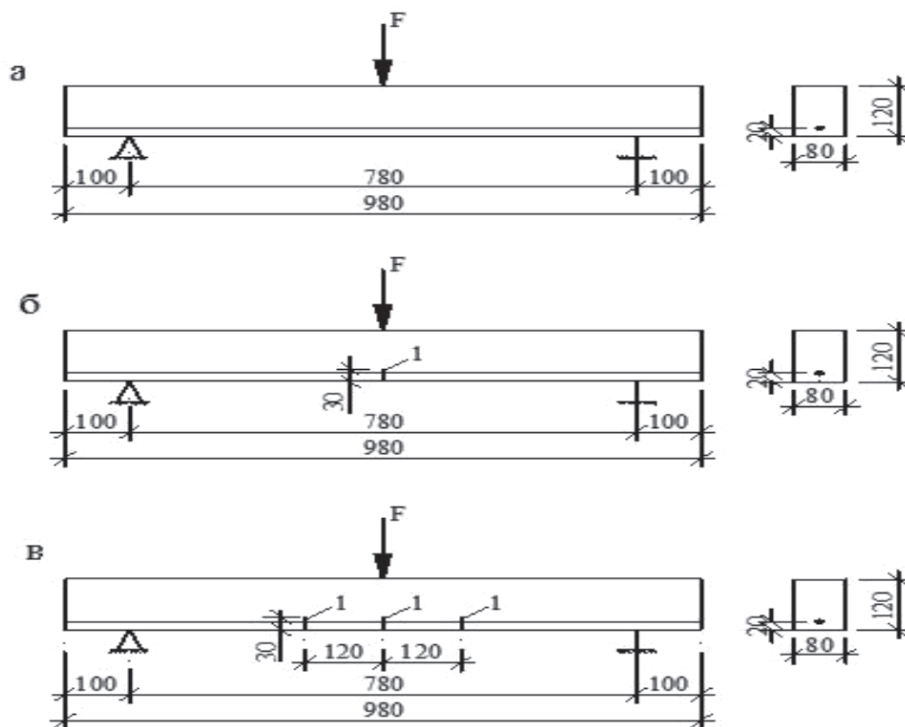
Схема железобетонной балки: а – без пластмассовых пластин (искусственных трещин); б – с одной пластмассовой пластиной; в – с тремя пластмассовыми пластинами; 1 – пластмассовая пластина (искусственная трещина)
